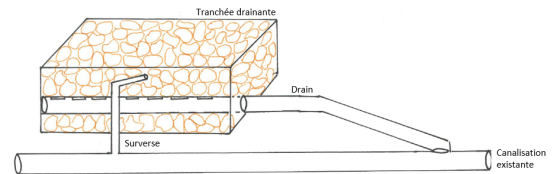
Schéma de principe de l'ouvrage de sortie de la tranchée drainante.
